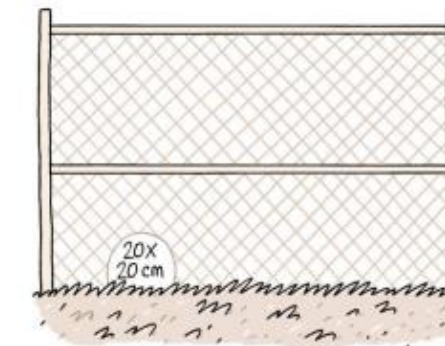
Passage à faune de 20 cm² sur grillage à mailles fines (Source : Bruxelles Environnement)
